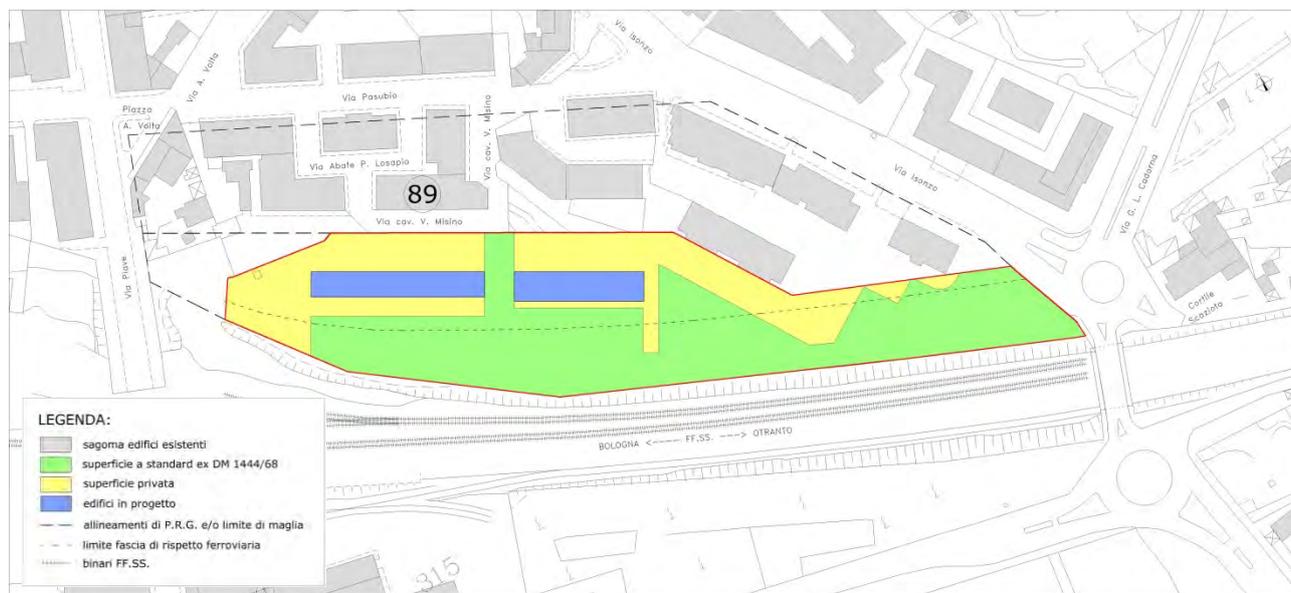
PLANIMETRIA DOTAZIONE STANDARD EX D.M. 1444/68
